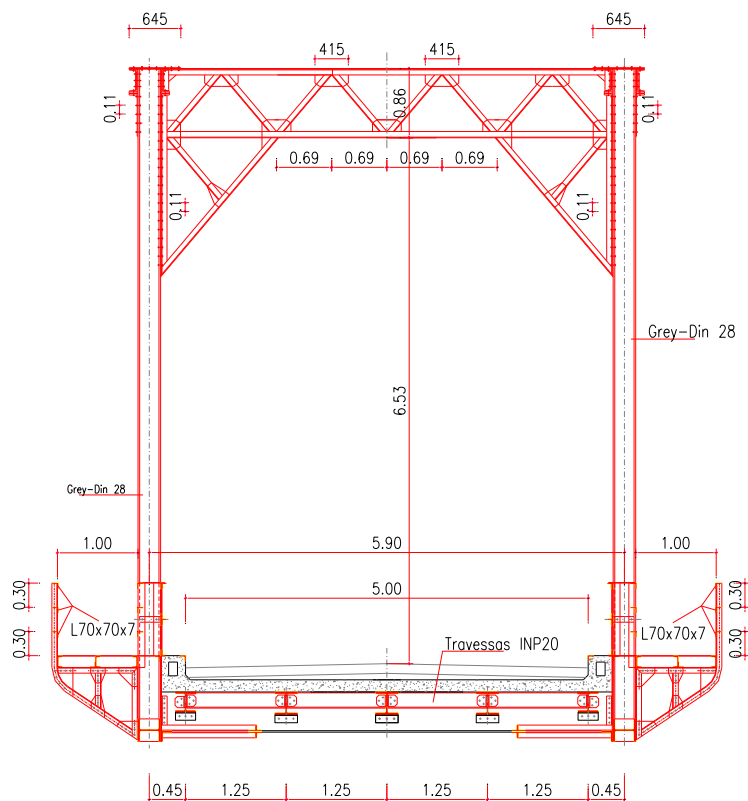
Secção Transversal (Fonte: Estradas de Portugal)
